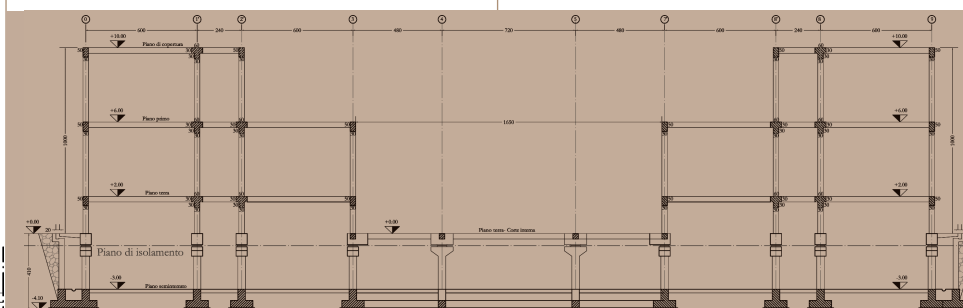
Sezione strutturale del Centro per laboratori d'arte. La linea rossa mostra il piano di isolamento
